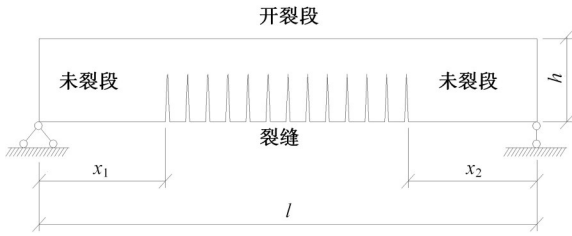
混凝土 T 梁开裂弯曲裂缝分布示意图
